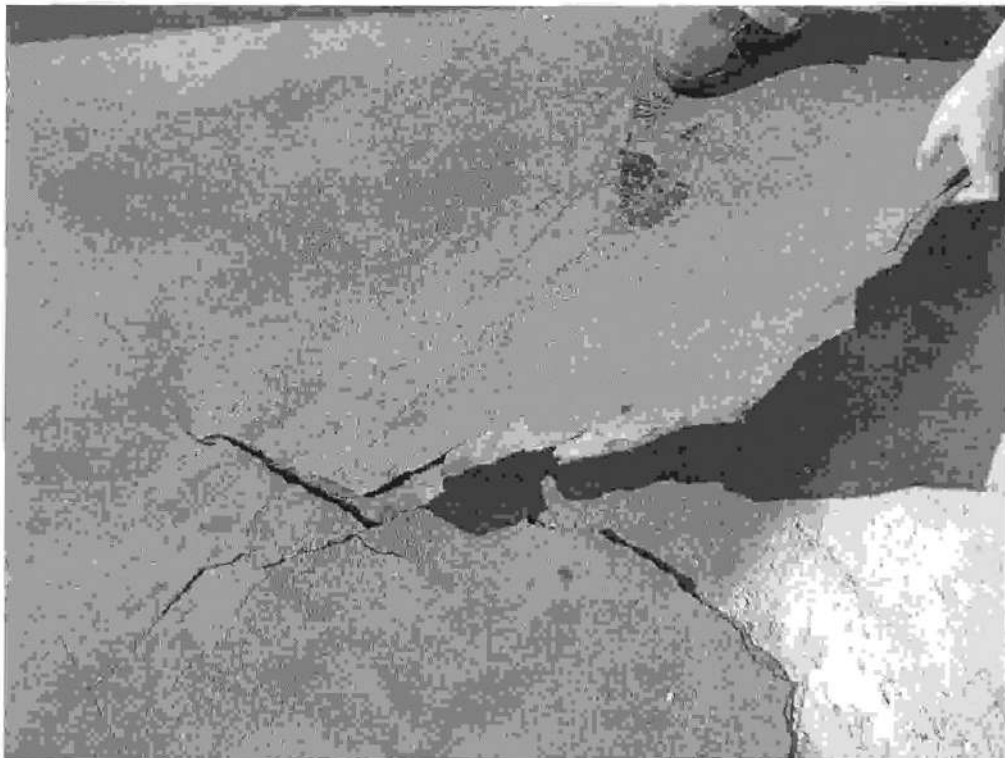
2 слоя кровельного покрытия. Секция 4 . Состояние на 01.04.2015г
